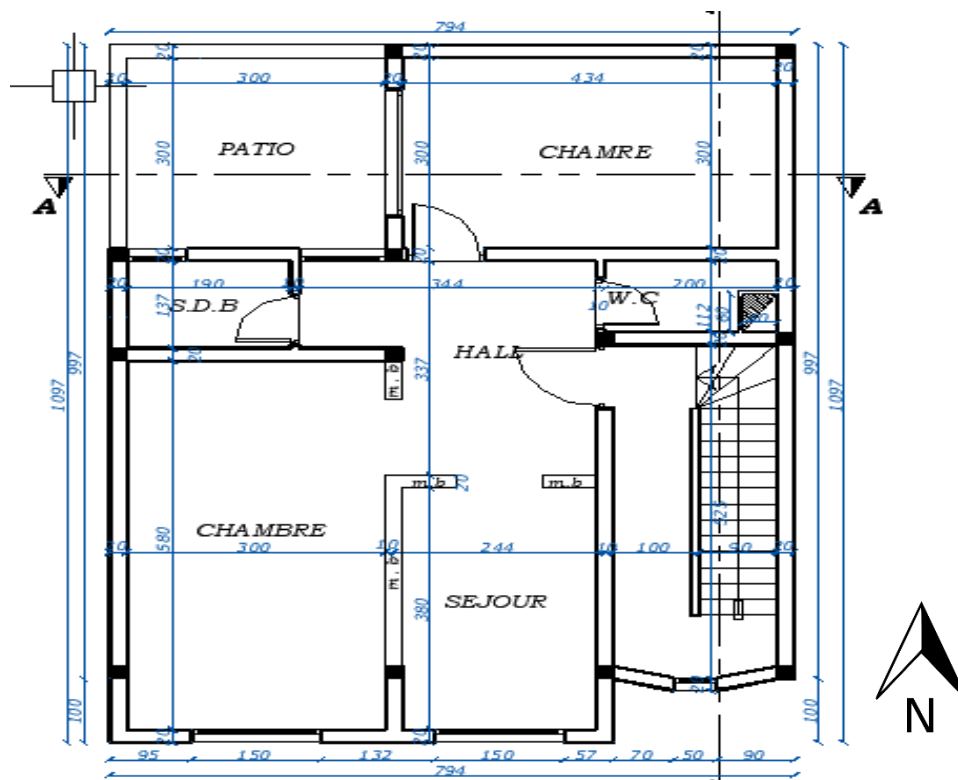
Plan architectural ( 1<sup>er</sup> étage)
